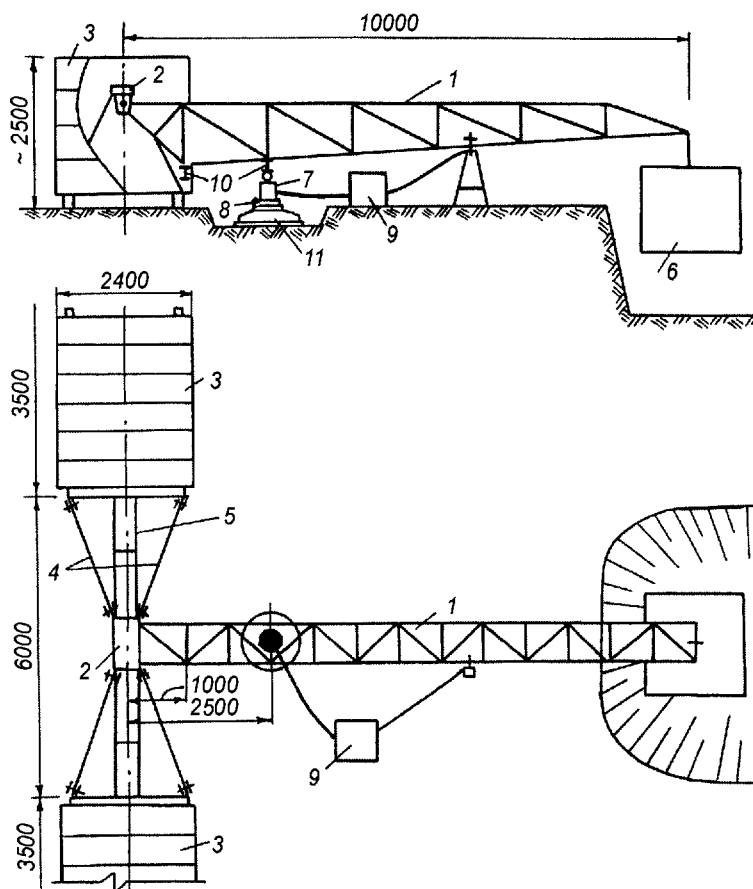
Конструкция загрузочного устройства для испытаний грунтов статическими нагрузками: 1 – рычаг; 2 – упорный узел; 3 – платформы с грузом; 4 – растяжки; 5 – плоская распорная рама; 6 – бак; 7 – гидравлический домкрат с шаровой пятой; 8 – динамометр; 9 – автоматическая насосная станция с устройством для поддержания рычага в заданном положении; 10 – опорные узлы; 11 – штамп
